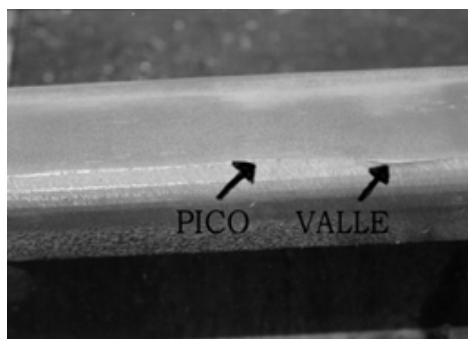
Vista general de las zonas de pico y valle en el riel retirado de la vía
